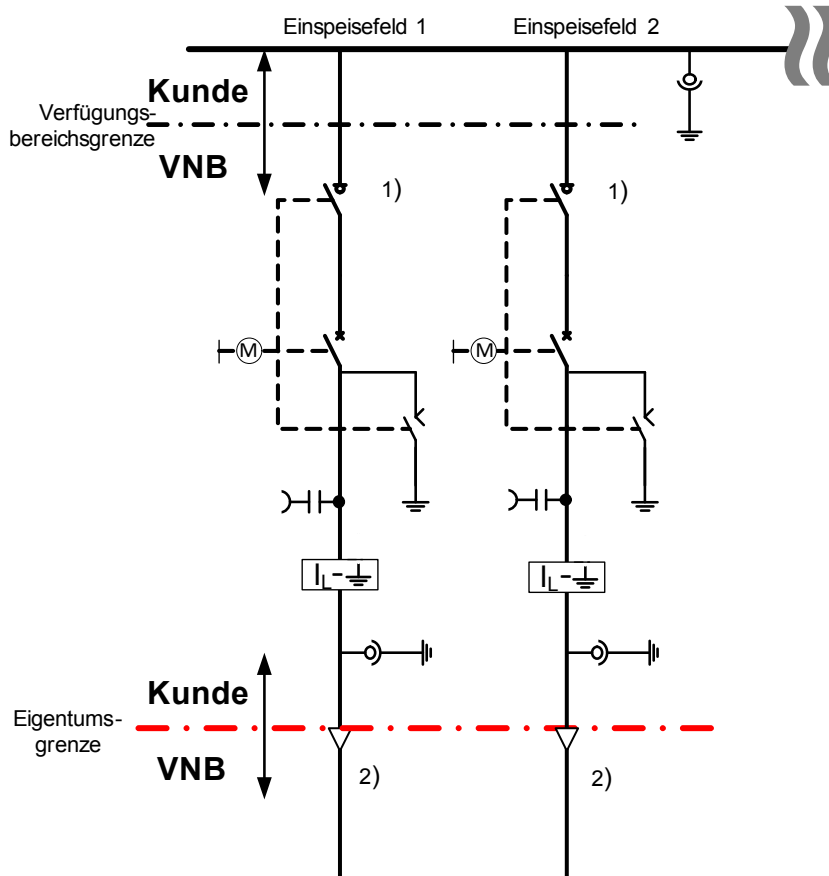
Grundaufbau einer 10 kV-Stichanbindung
